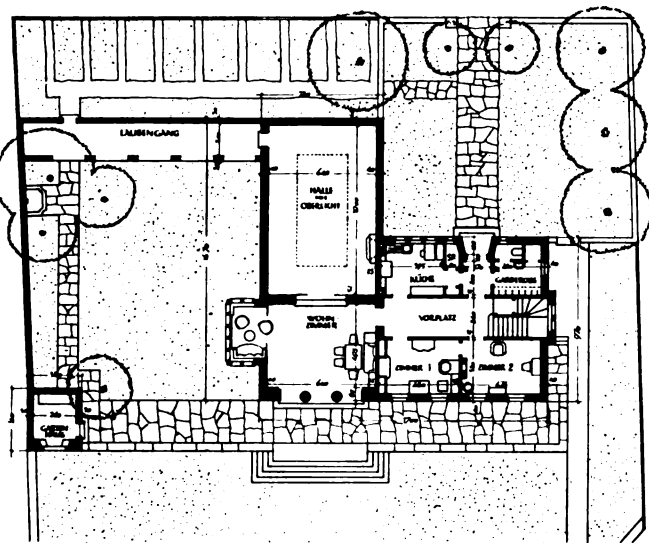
bis 6. Grundrisse vom Erdgeschoss, Obergeschoss und Untergeschoss 1:450 des Landhauses in Rüschlikon. — Arch. Vogelsanger & Maurer, Rüschlikon.
